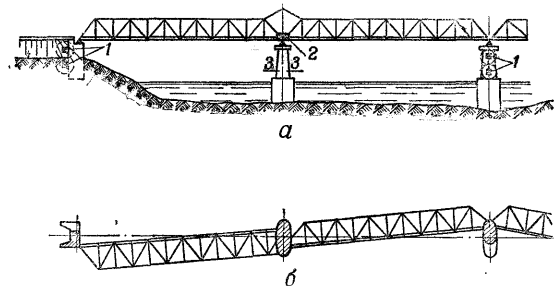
Подрывание большепролетного металлического моста с пролетными строениями неразрезной конструкции:
